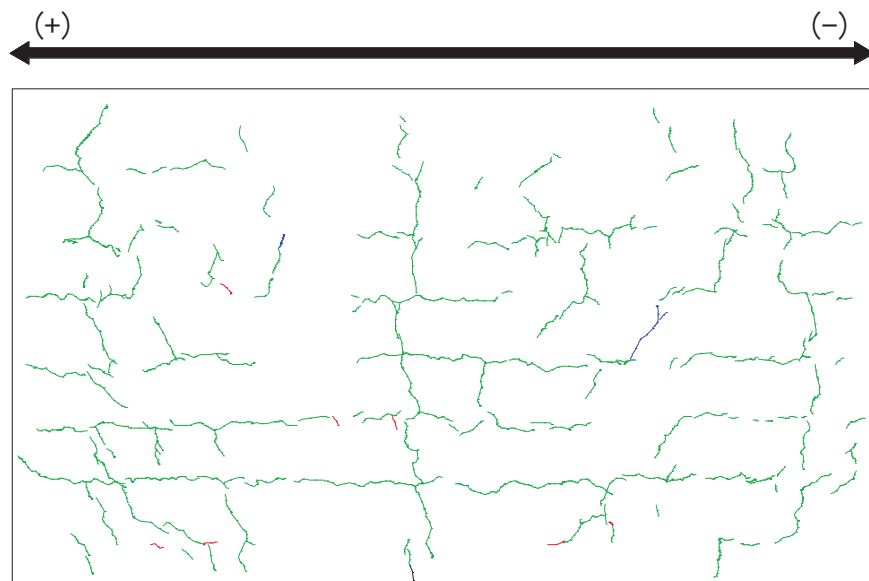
(2) 乾燥試験体 [2] 1/10000rad. におけるひび割れ図
